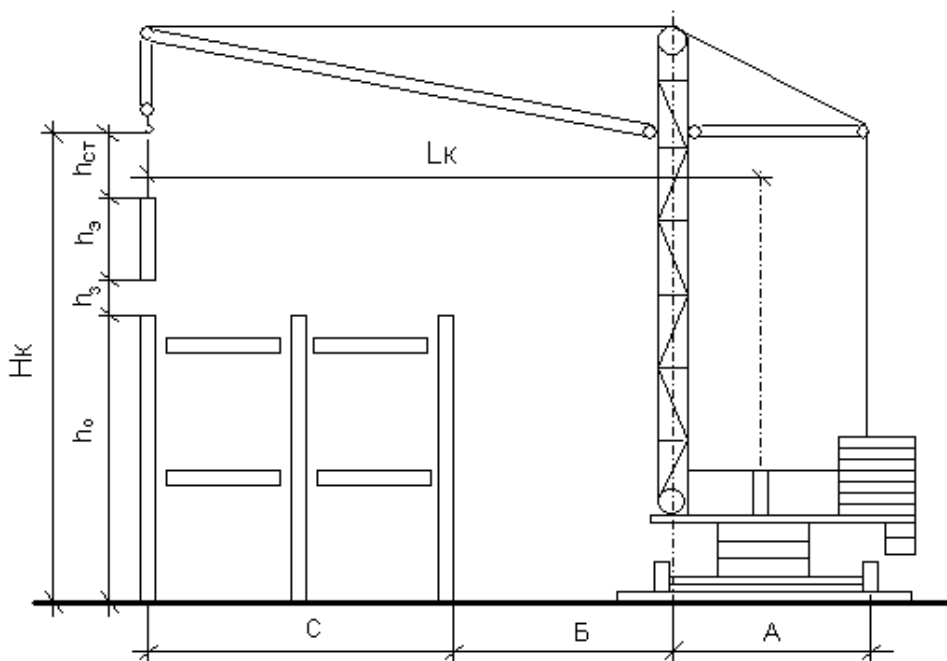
Схема для определения требуемых технических параметров башенного крана. Поперечная привязка башенного крана к зданию.
